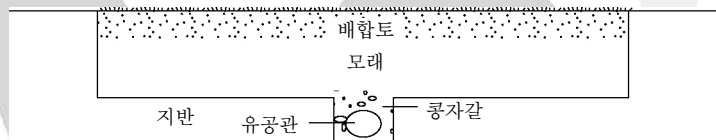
모래층지반(thin rootzone-two layer system)
